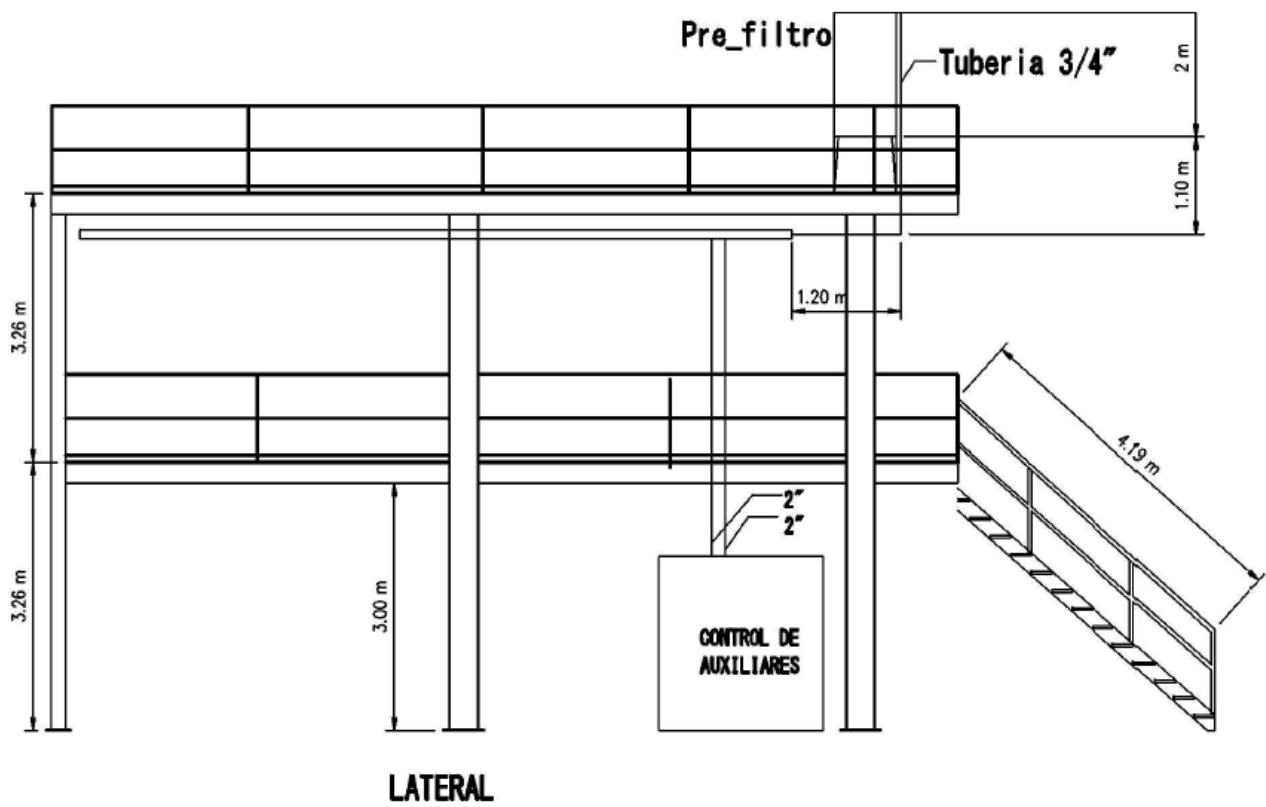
sección de tubería para pre-filtro con llegada a ducto 4x4\"/>
